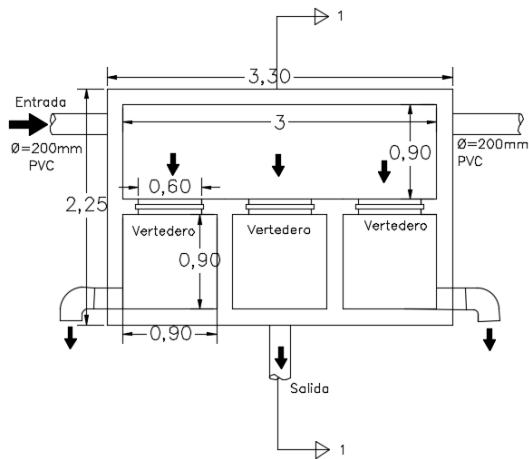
Vista en planta caja separadora de caudal de la planta N°14. Basado en Moscoso (2006).
